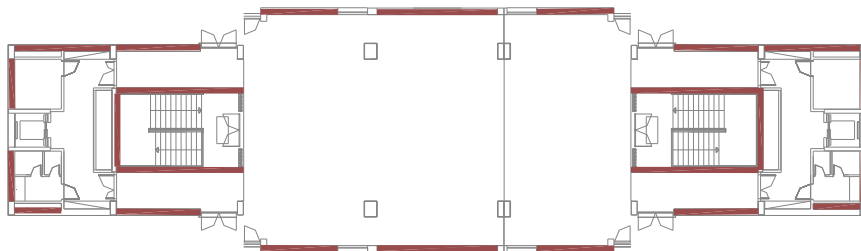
Planta arquitetônica com a disposição dos painéis de alvenaria do piso 4.
